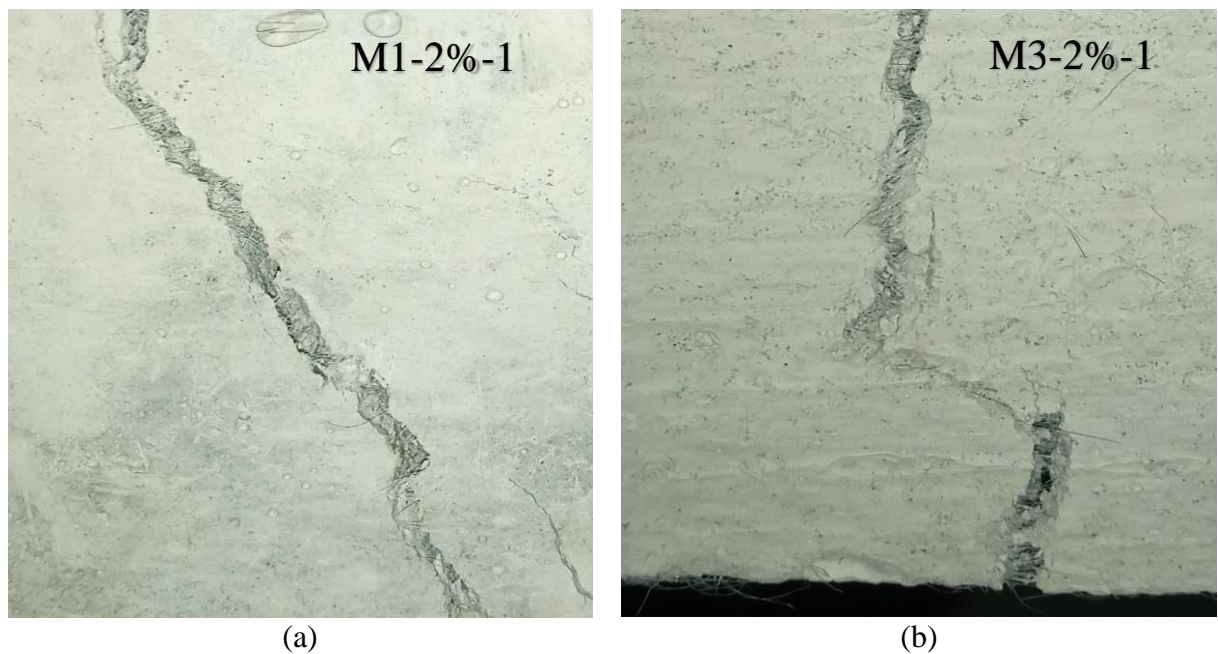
Efecto de puente dentro de la grieta vista por (a) debajo y (b) por un costado de la vigueta.
